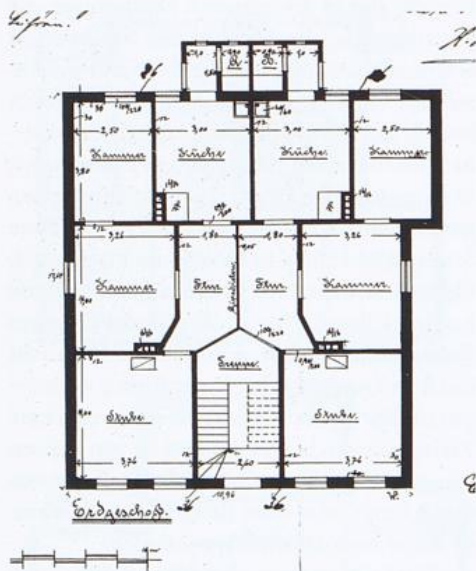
Grundriss eines Giebelhauses der Spätform, Heinrichstraße 25
